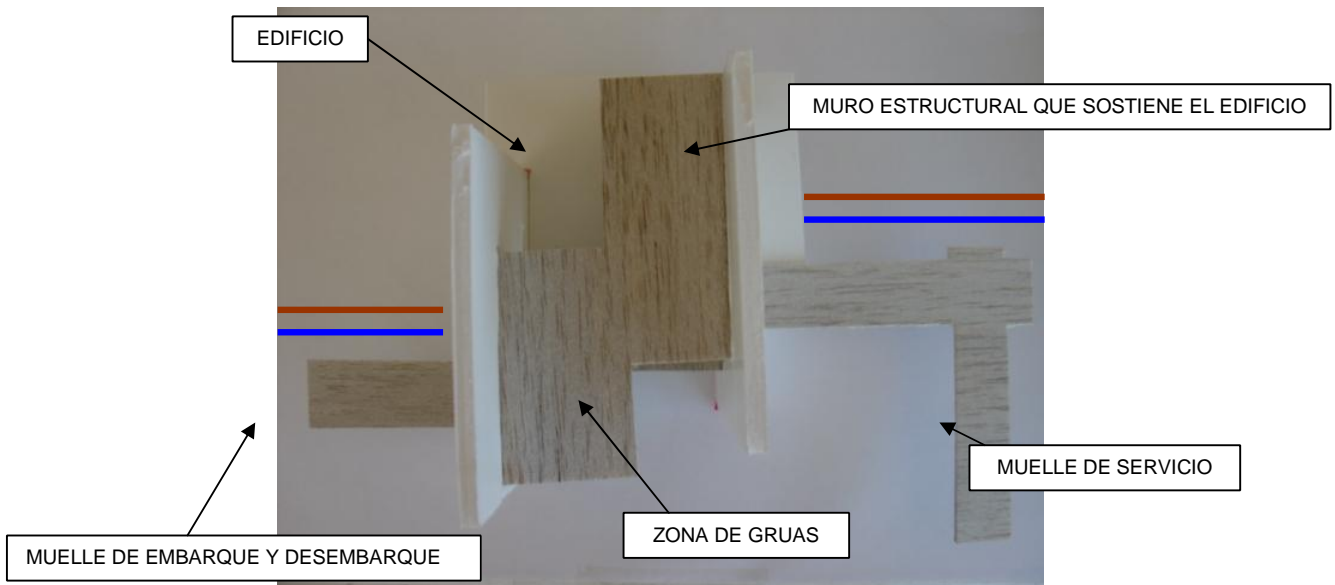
Vista en planta del tercer modelo experimental.
